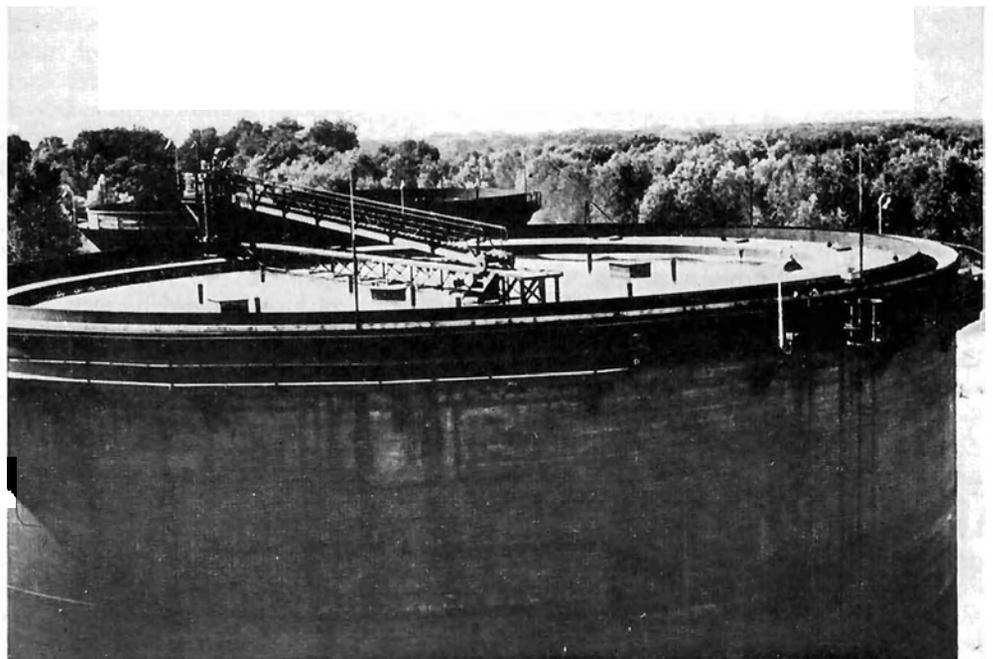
Schwimmdachbehälter mit einer aufgebrauchten Dachauflast von 50 t Wasser
